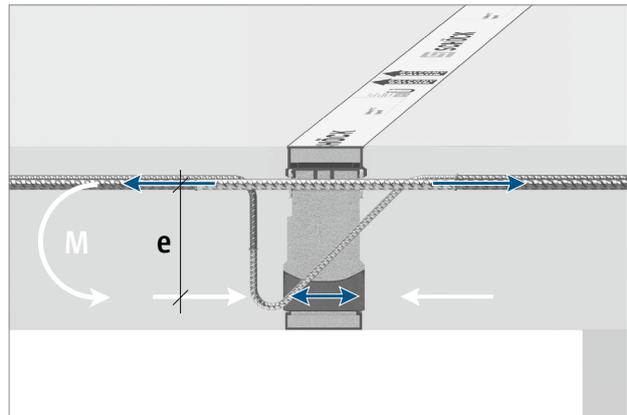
Schöck Isokorb® T Typ KL: Lastabtragung Moment
